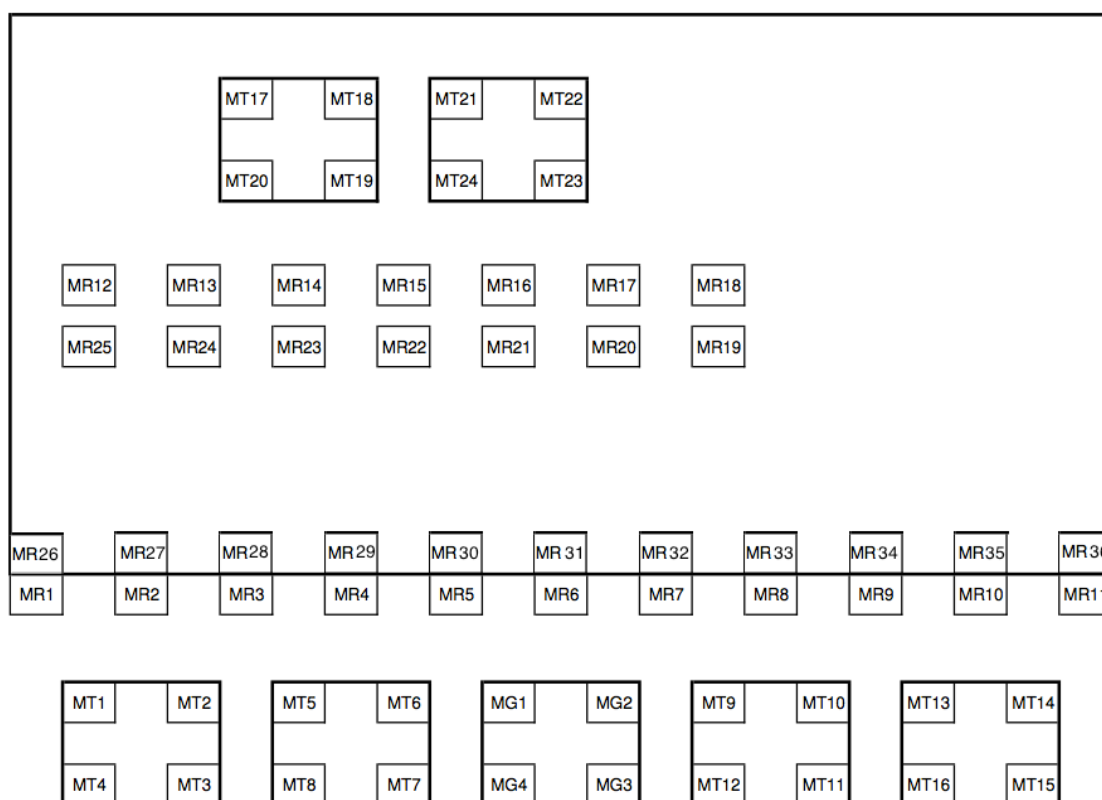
| Planta com a localização das microestacas de recalçamento de fachada, grua e estrutura metálica
